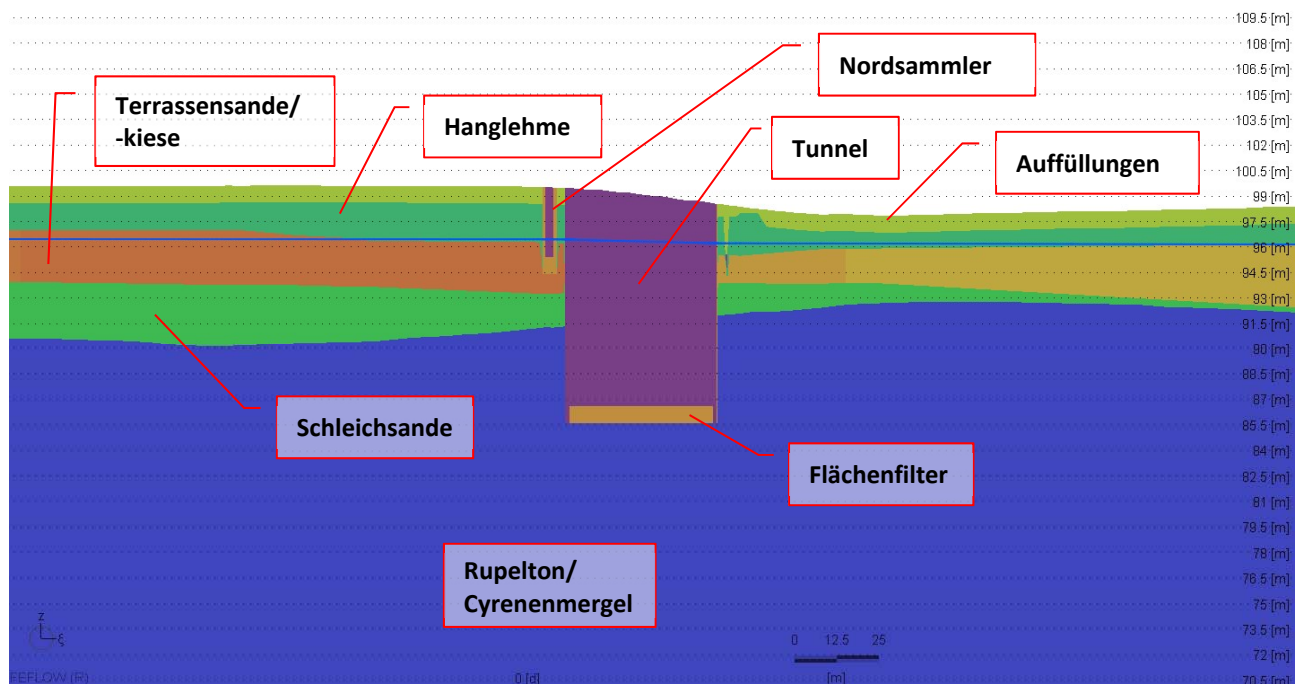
Modellaufbau (10-fach überhöht) Schnitt Tunnelmitte (km 2+250)
